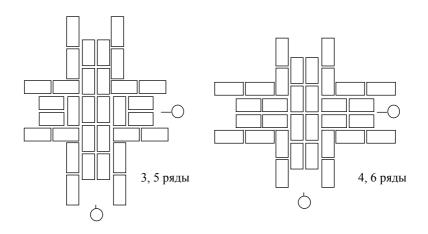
Кладка пересечений стен толщиной в 2 кирпича
